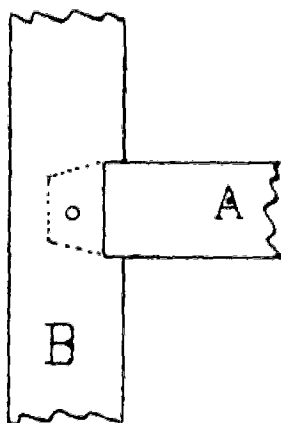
Assemblage par tenon et mortaise avec encastrement.
